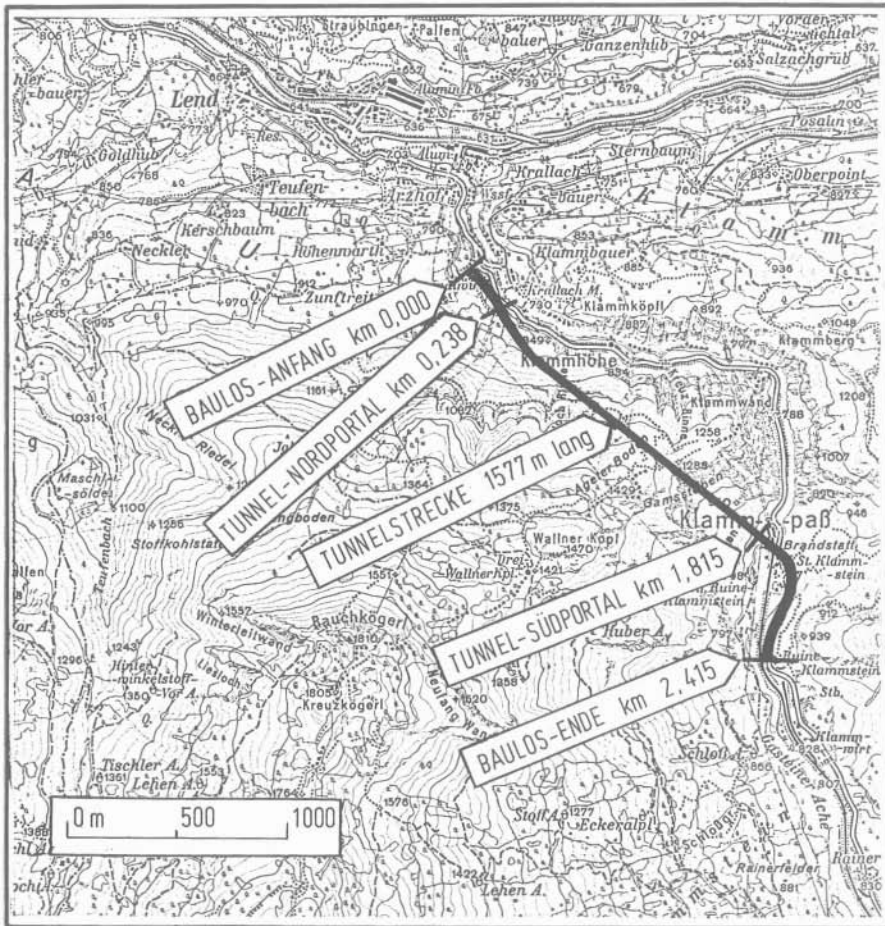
Lageplan des Bauloses „Klamm“ der Gasteiner Bundesstraße B 167
